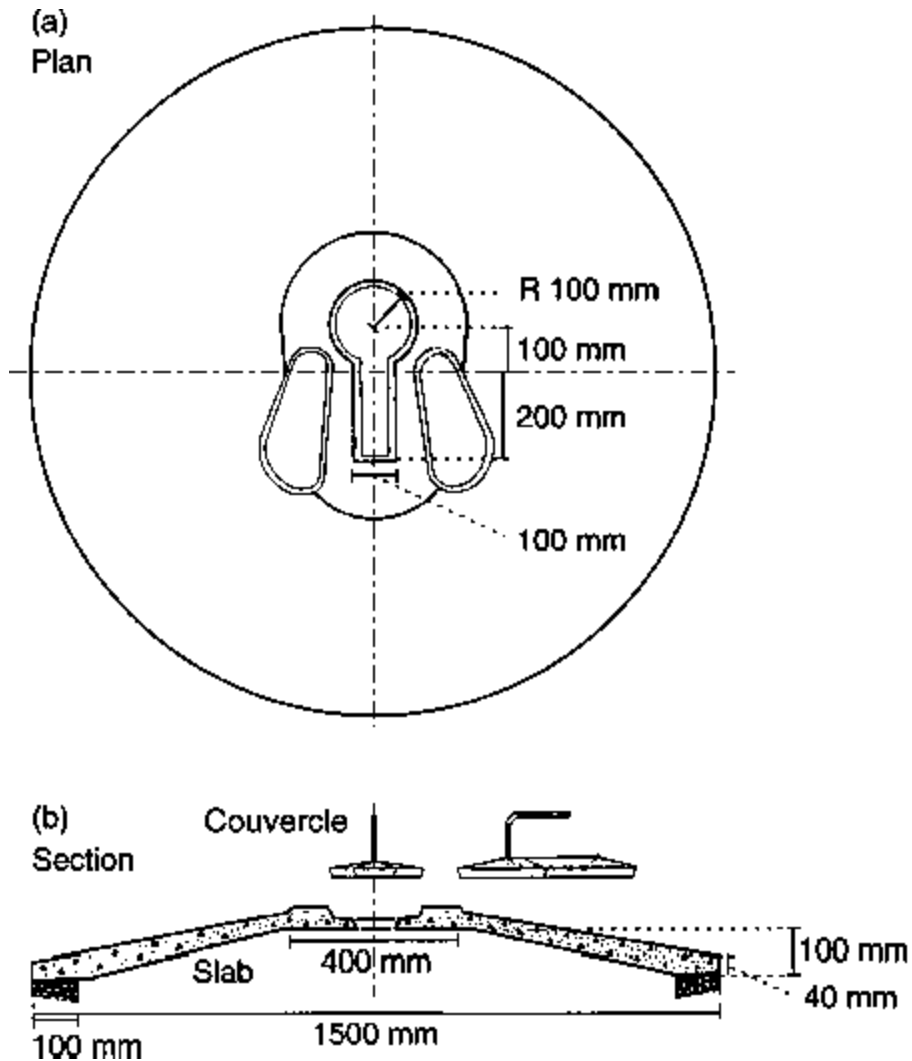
Couvercle de latrine à l'épreuve des moustiques: a) vue en plan et b) vue en coupe avec cotes en millimètres (169). Copyright John Wiley & Sons Limited.
